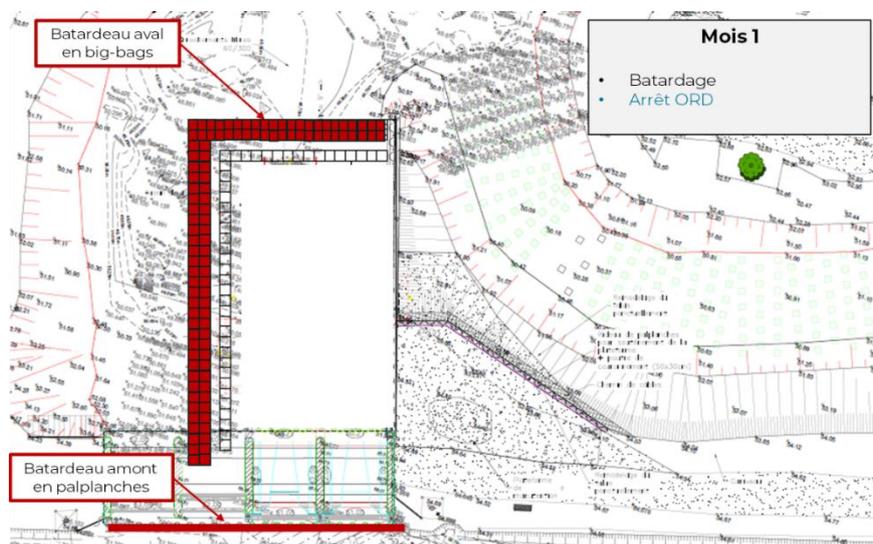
Vue en plan avec positionnement des batardeaux amont et aval
